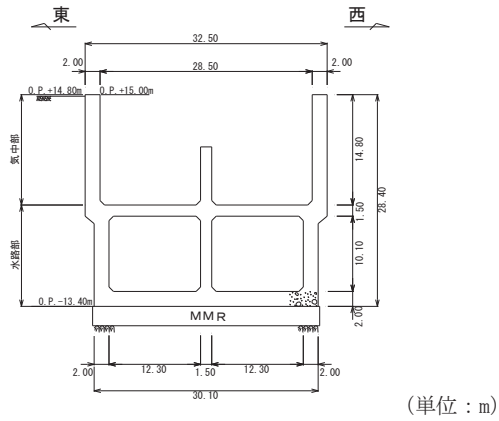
海水ポンプ室断面図 (C-C 断面, 東西)
